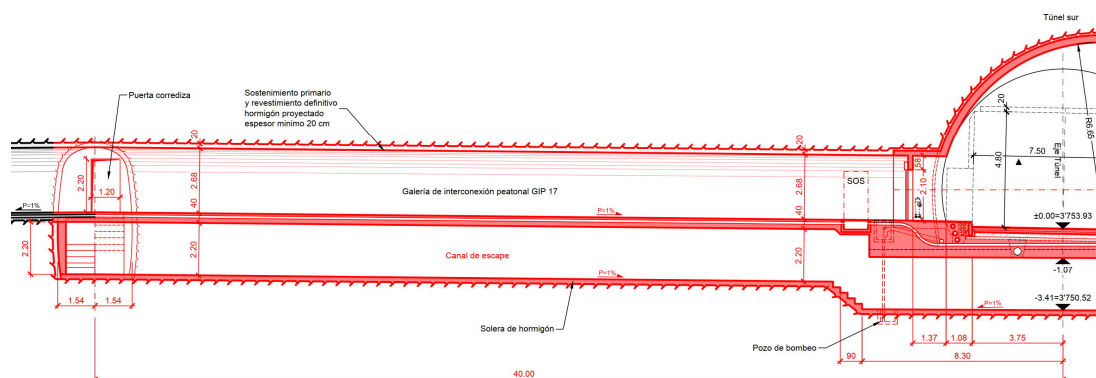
Sección longitudinal del GIP 17 con canal de escape del Laboratorio
